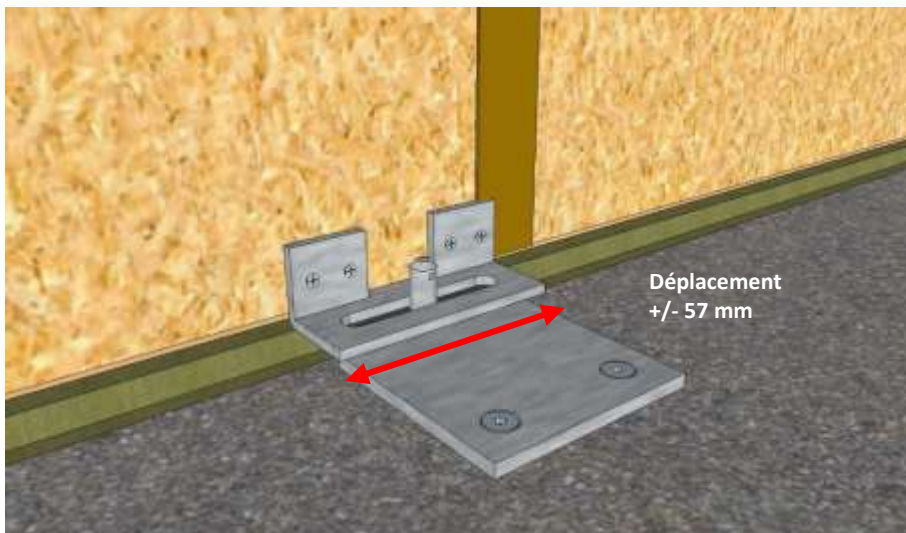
Insertion de la poignée au niveau de l'axe vertical de la platine support. Déplacement horizontal parallèle à la façade, possible de +/- 57 mm (cas des façades indépendantes par niveau)
